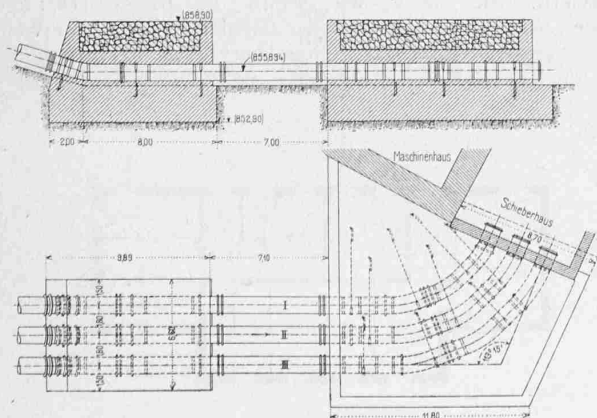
Grundriss und Längsschnitt. — Masstab 1 : 400.
